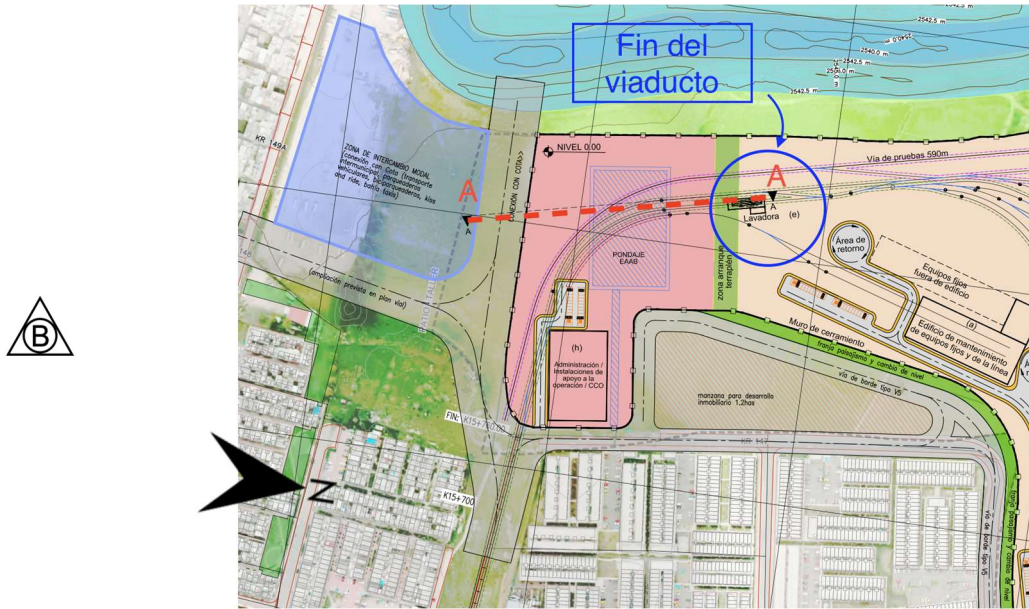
Planta de la bajada al Patio Taller según el predimensionamiento planteado en la Prefactibilidad.
